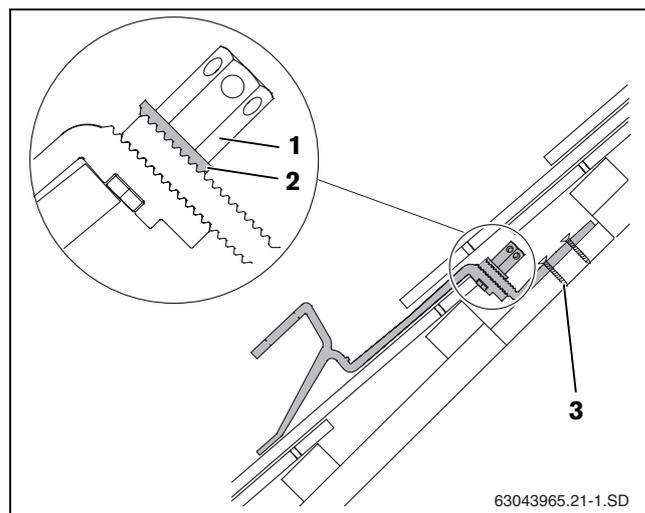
Gancio da tetto montato. Vista in sezione con parte inferiore del gancio da tetto ridotta
